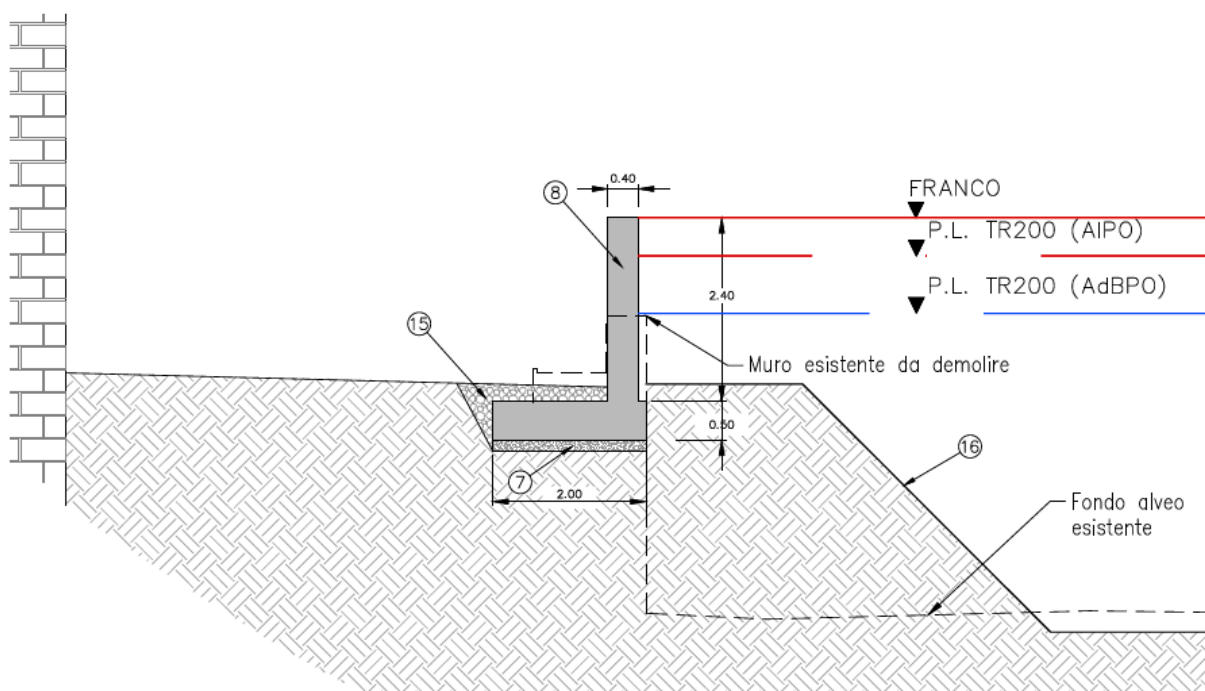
Sezione tipo G (intervento 7 e 8)
